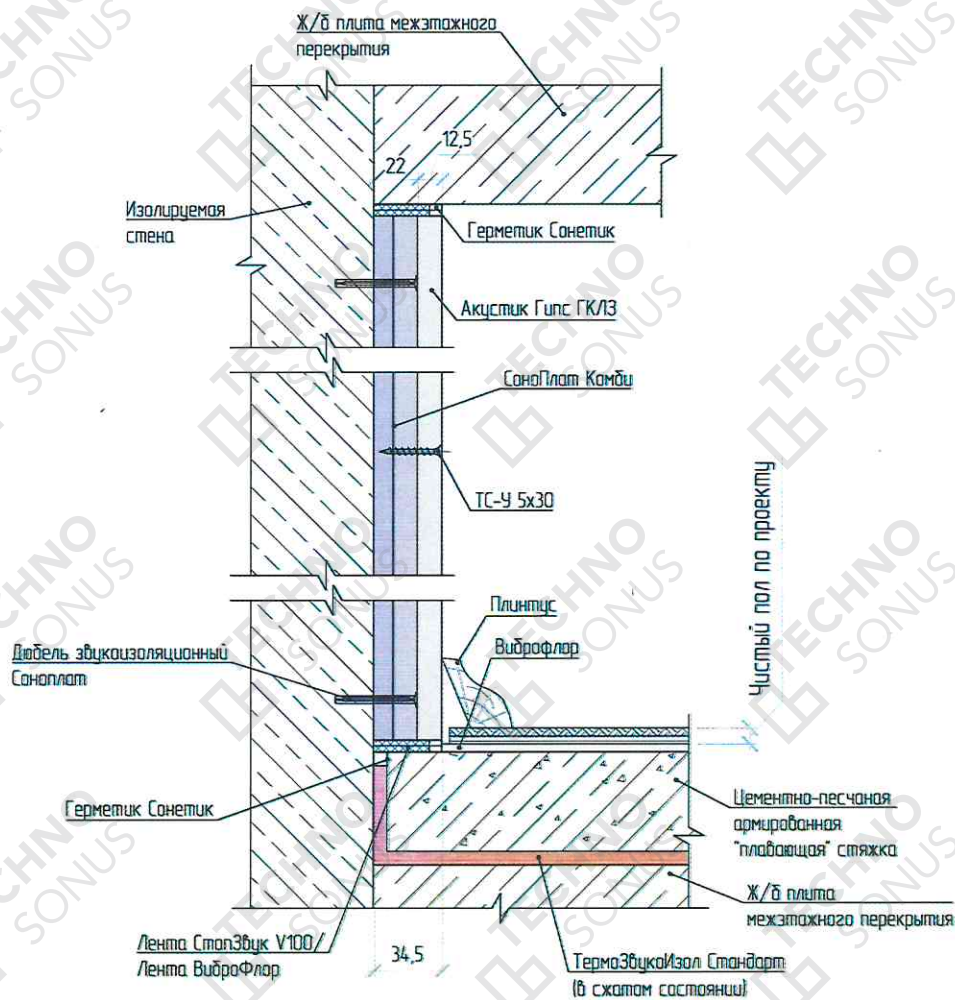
Примыкание облицовки стены «Слим П» к «плавающей» стяжке пола и к плите перекрытия
